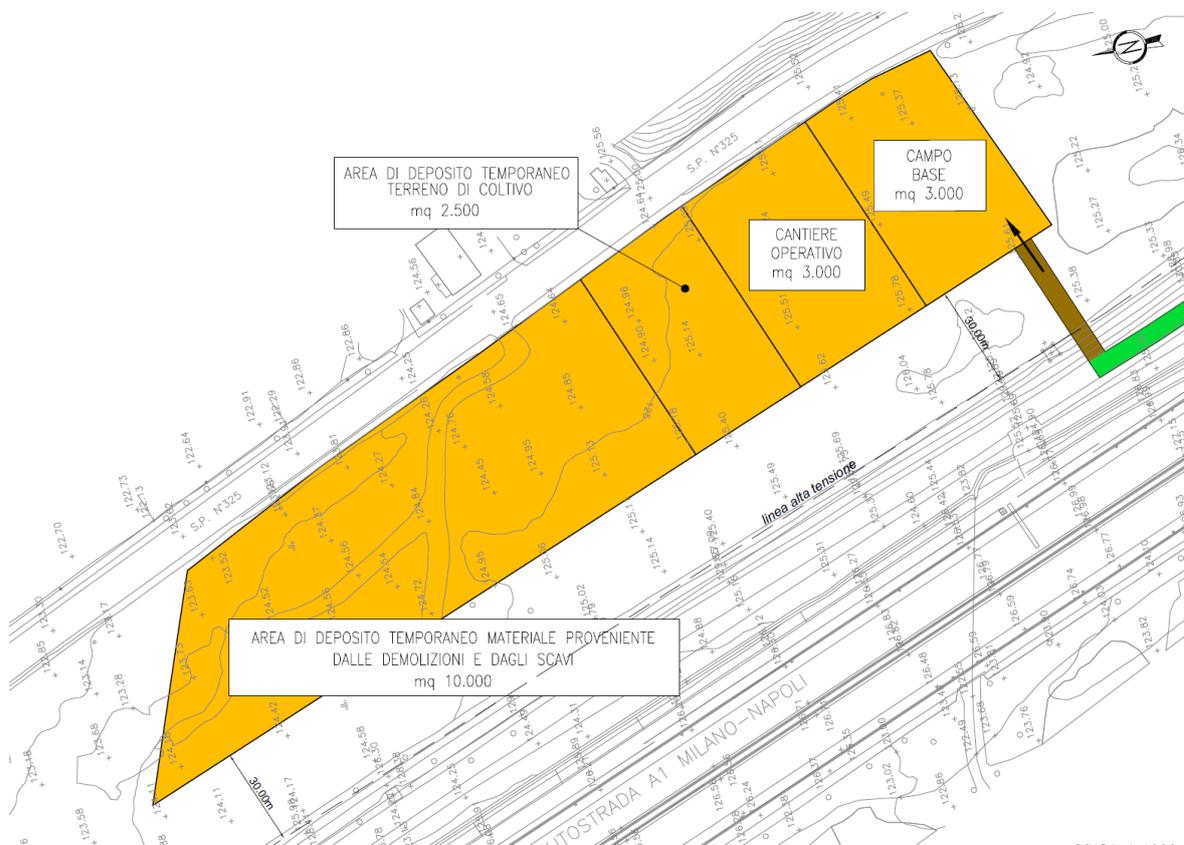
Suddivisione dell’area di cantiere in zone funzionali
